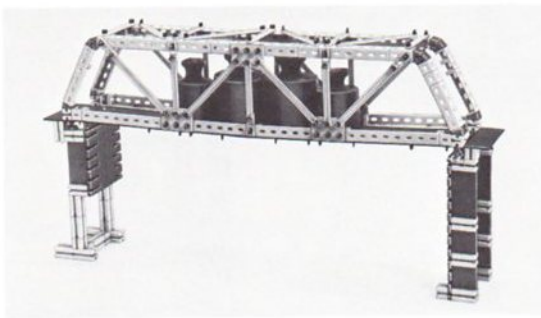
Fachwerk-Balkenbrücke mit Knotenplatten-Ausbildung im Inneren des Fachwerkverbandes.
